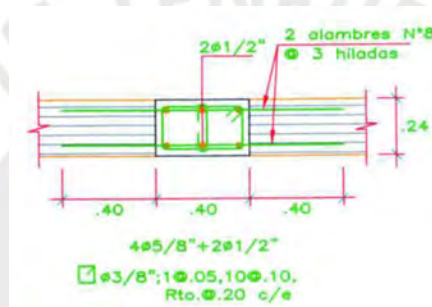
Sección de columna rectangular de piso típico (Autocad)
